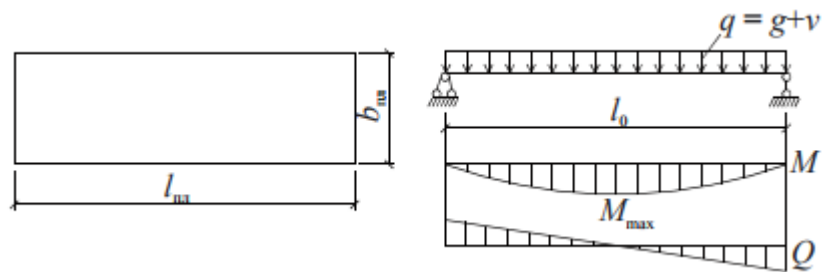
Розрахункова схема та епюри внутрішніх зусиль в багатопустотній плиті перекриття.
